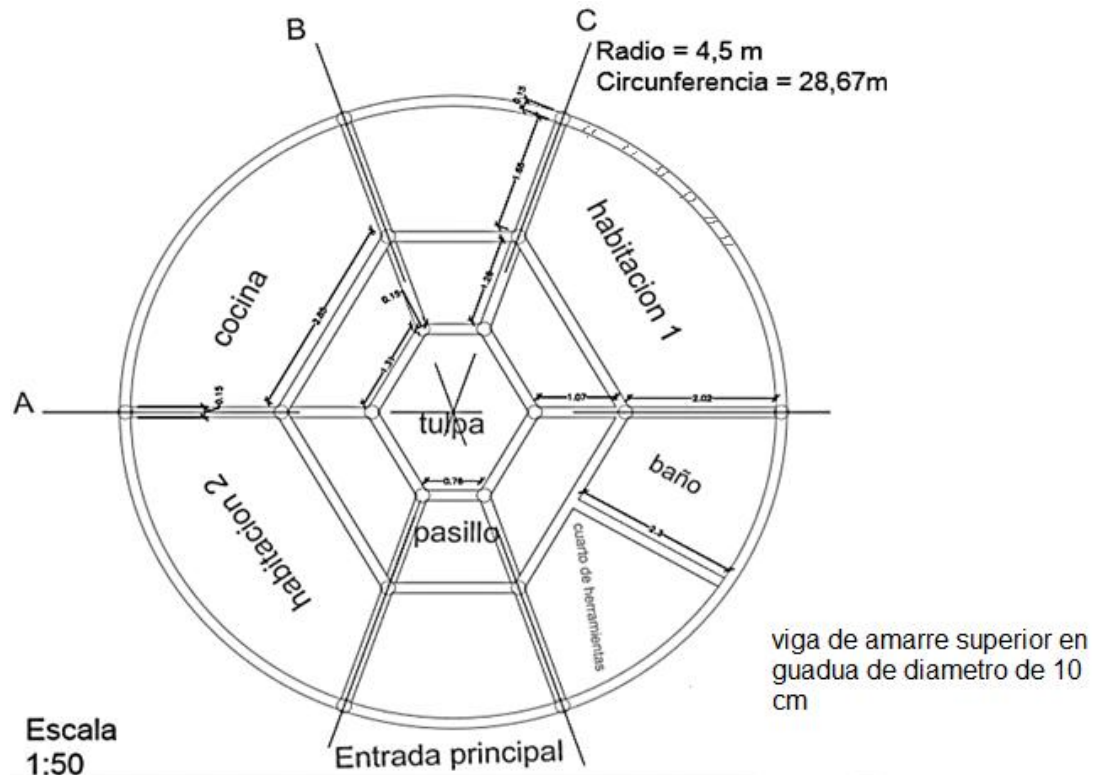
se detalla la viga de amarre superior en guadua de diámetro de 10cm. En toda la longitud.
